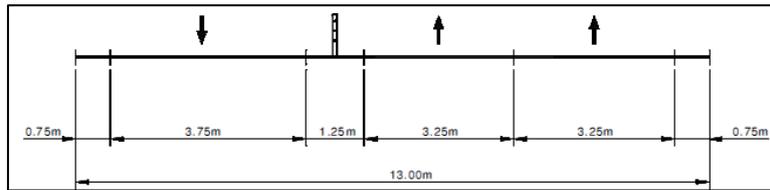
Sección existente de carretera 2+1 con barrera de cables en Suecia (Fuente: Referencia 1).
